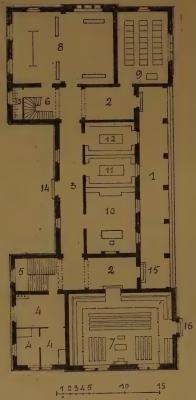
Lycée de jeunes filles, à Neufchâtel, plan du rez-de-chaussée.
